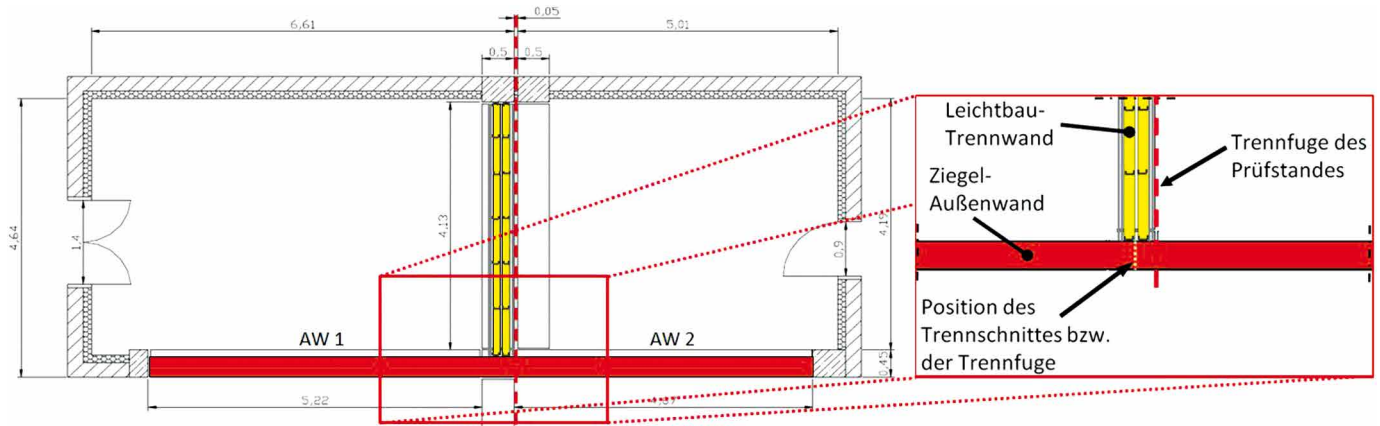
Grundriss-Skizze des Flankenprüfstandes und der untersuchten Stoßstelle
